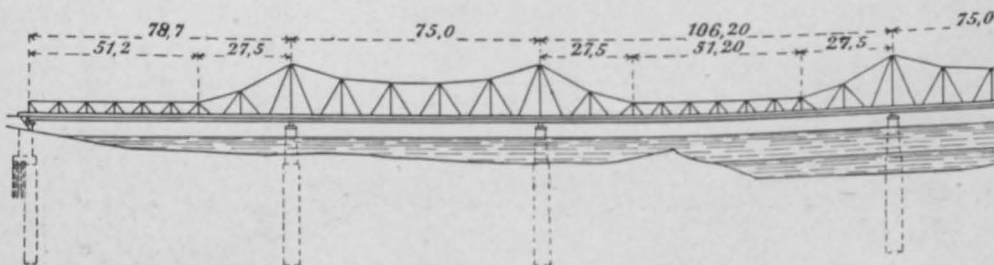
Straßenbrücke über den roten Fluß in Tonkin. 1898.
